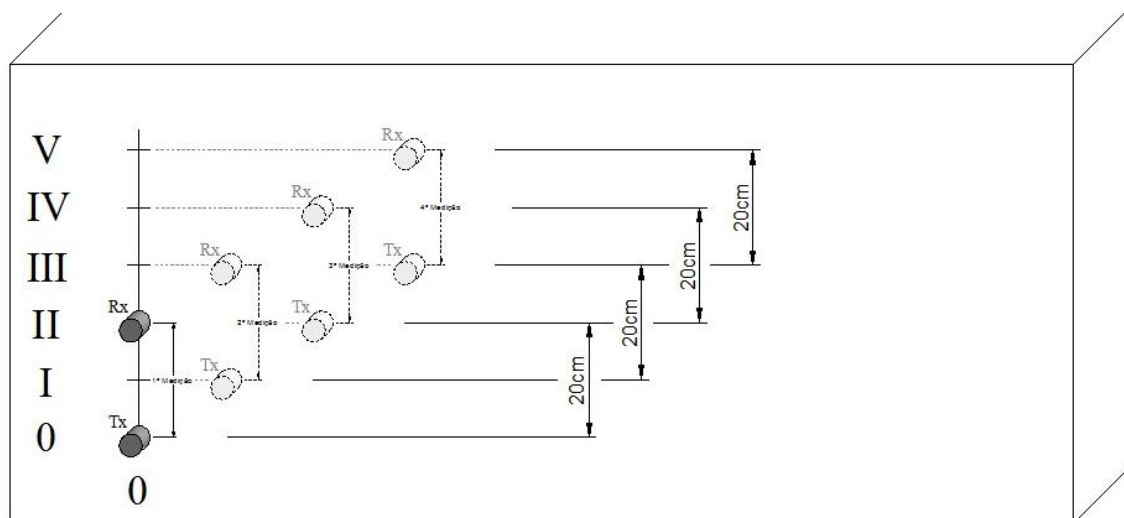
Esquema do Ensaio 1 com espaçamento entre linhas de vinte centímetros em uma das colunas.
